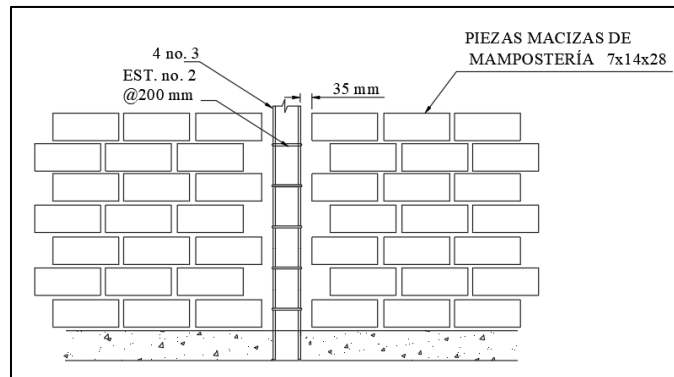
Detalle de dentado en muros de mampostería con nuevos castillos
